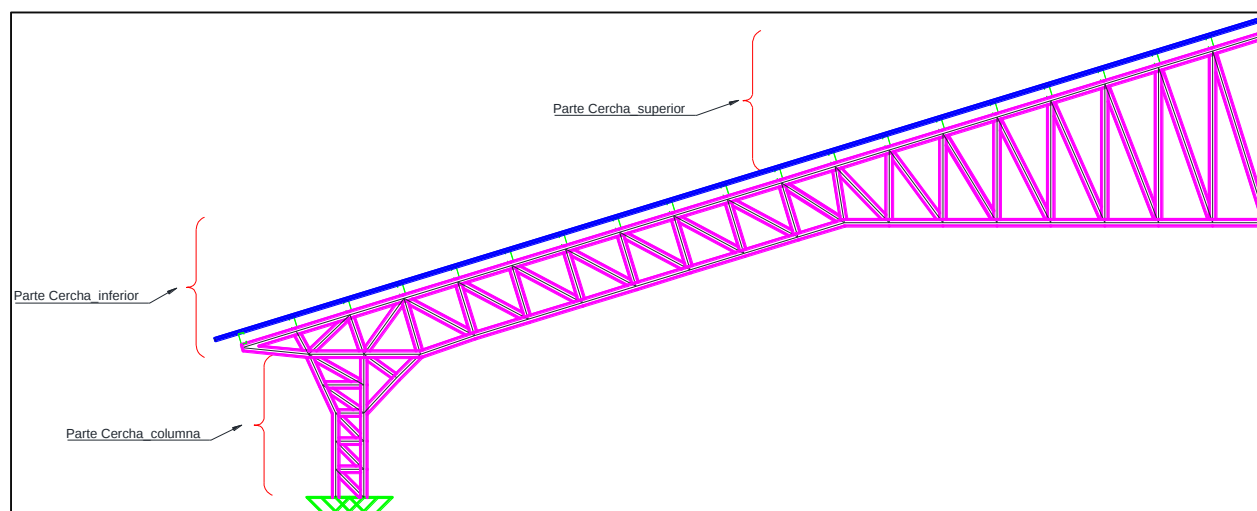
Cercha Celosía dividida por partes; Elaboración Propia
